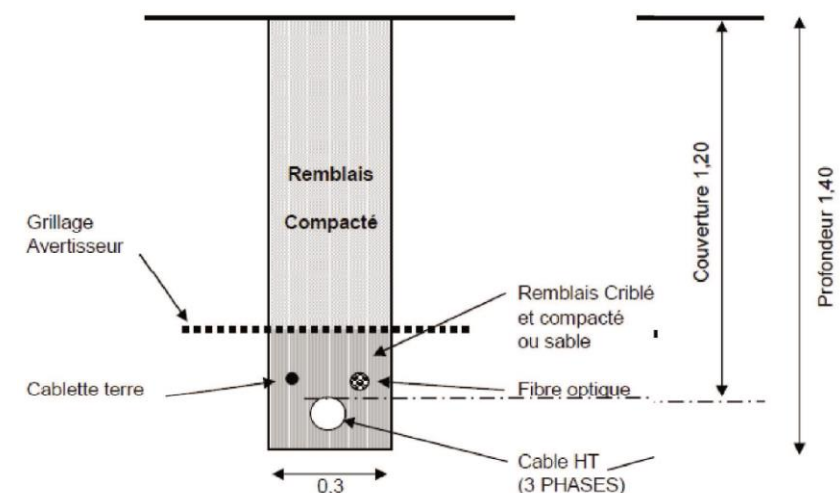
Coupe type d'une tranchée accueillant le câblage (Source : BE Jacquel et Chatillon)
